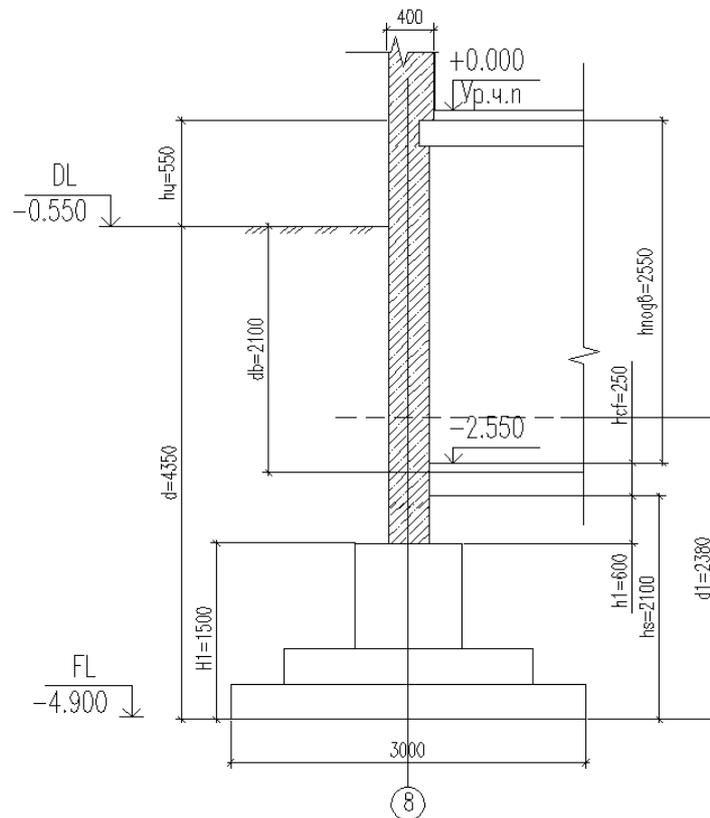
Схема определения глубины заложения фундамента по конструктивным требованиям.
